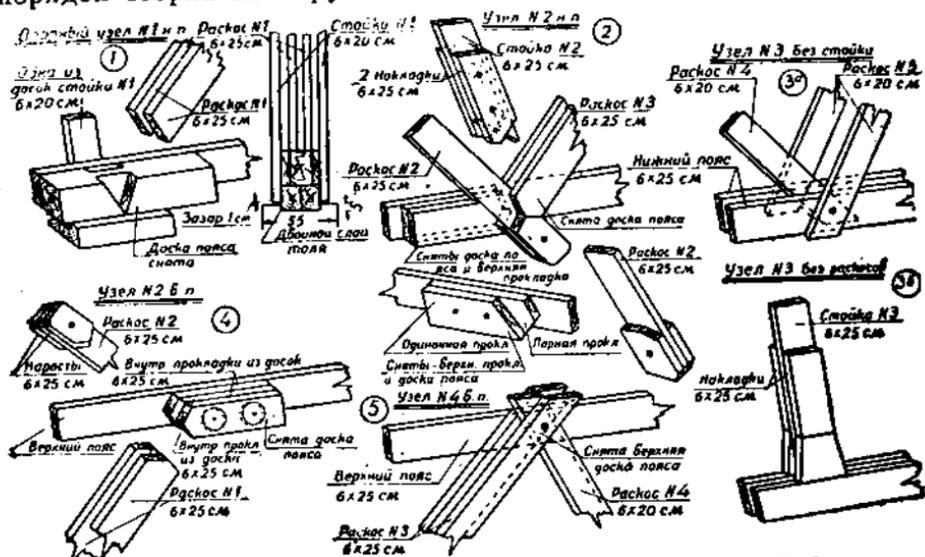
б. Детали: 1—опорного узла № 1 нижнего пояса, 2—узла № 2 нижнего пояса, 3-а—узла № 3 нижнего пояса без стойки, 3-б—то же без раскосов, 4—узла № 2 верхнего пояса, 5—узла № 4 верхнего пояса.
